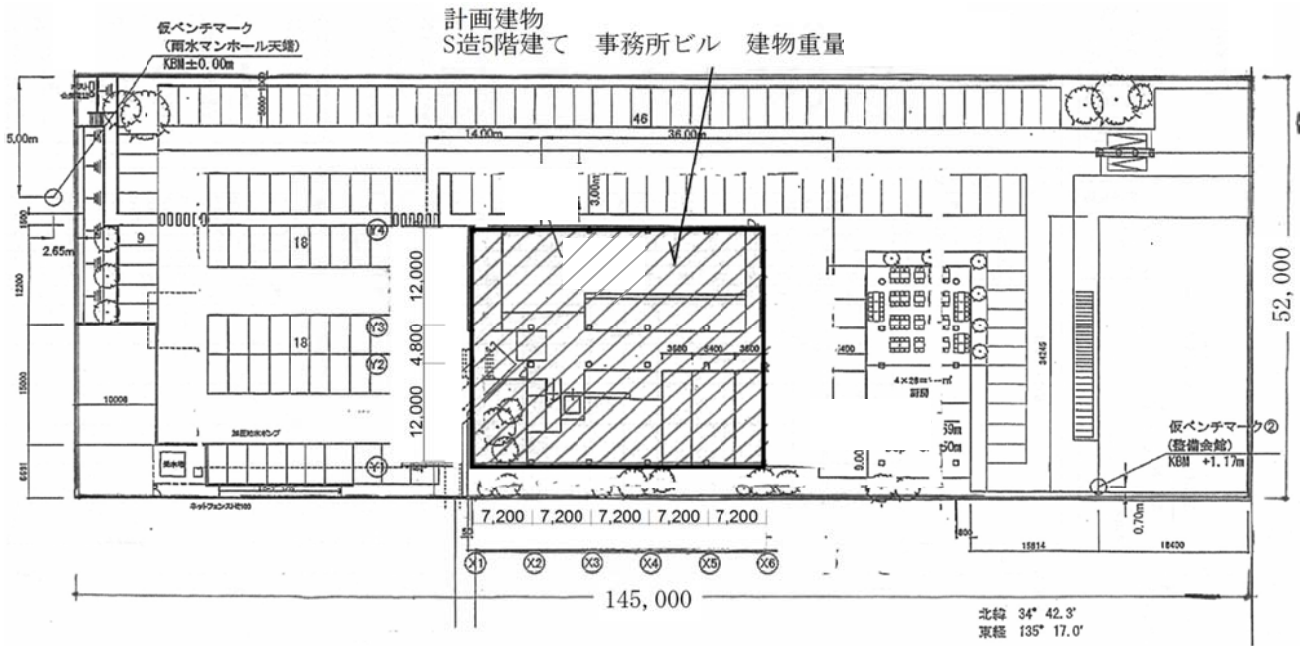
敷地および事務所ビルの配置計画図 (単位 mm)
